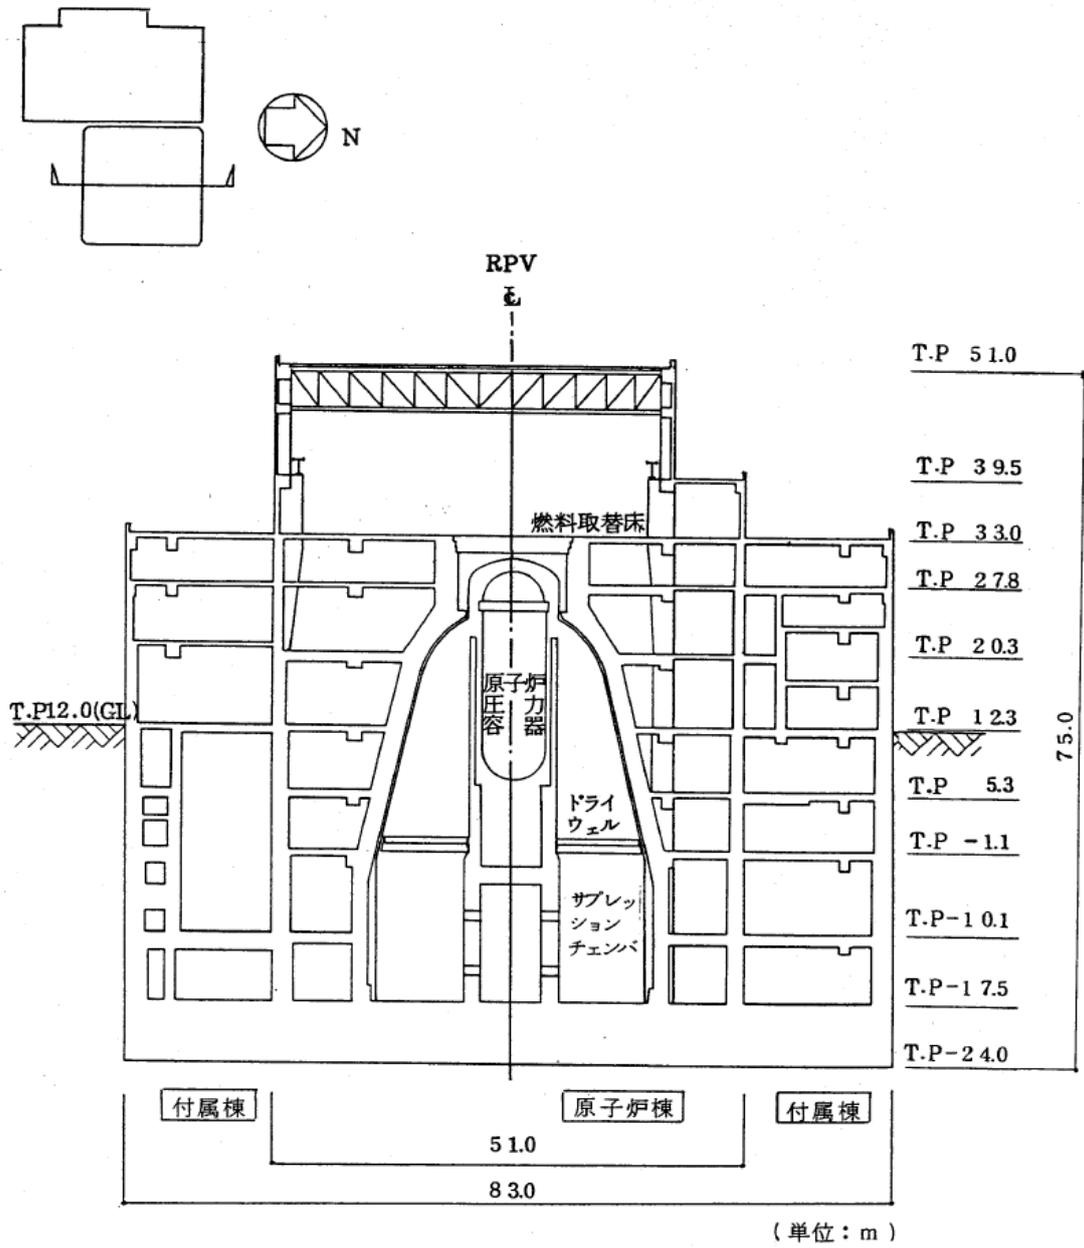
5号炉原子炉建屋断面図 (NS 方向)
